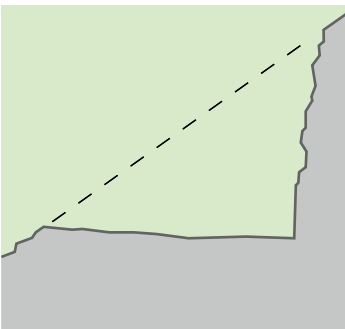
Sezione tipo nella roccia. Piano di calpestio con lieve pendenza verso monte. Occorre garantire sufficiente libertà di movimento all'altezza delle spalle.
